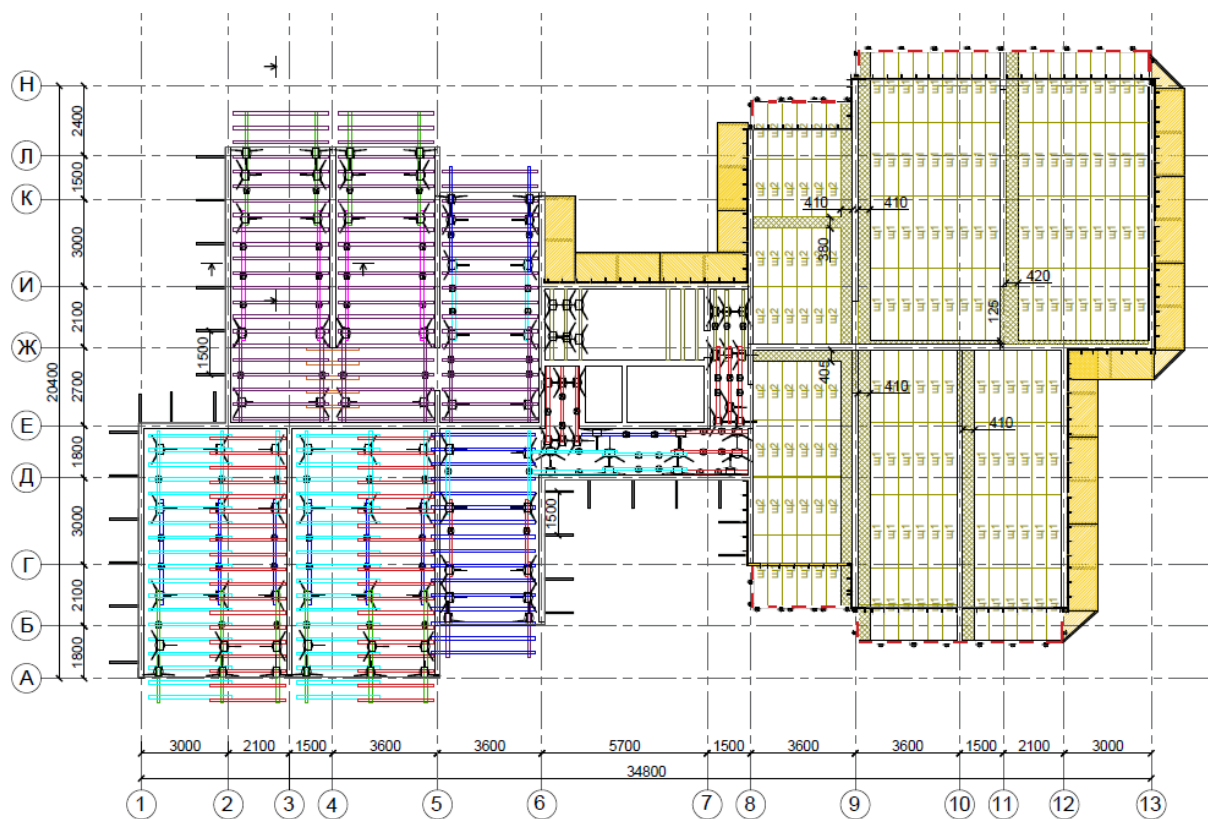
Схема расстановки опалубки горизонтальных конструкций
